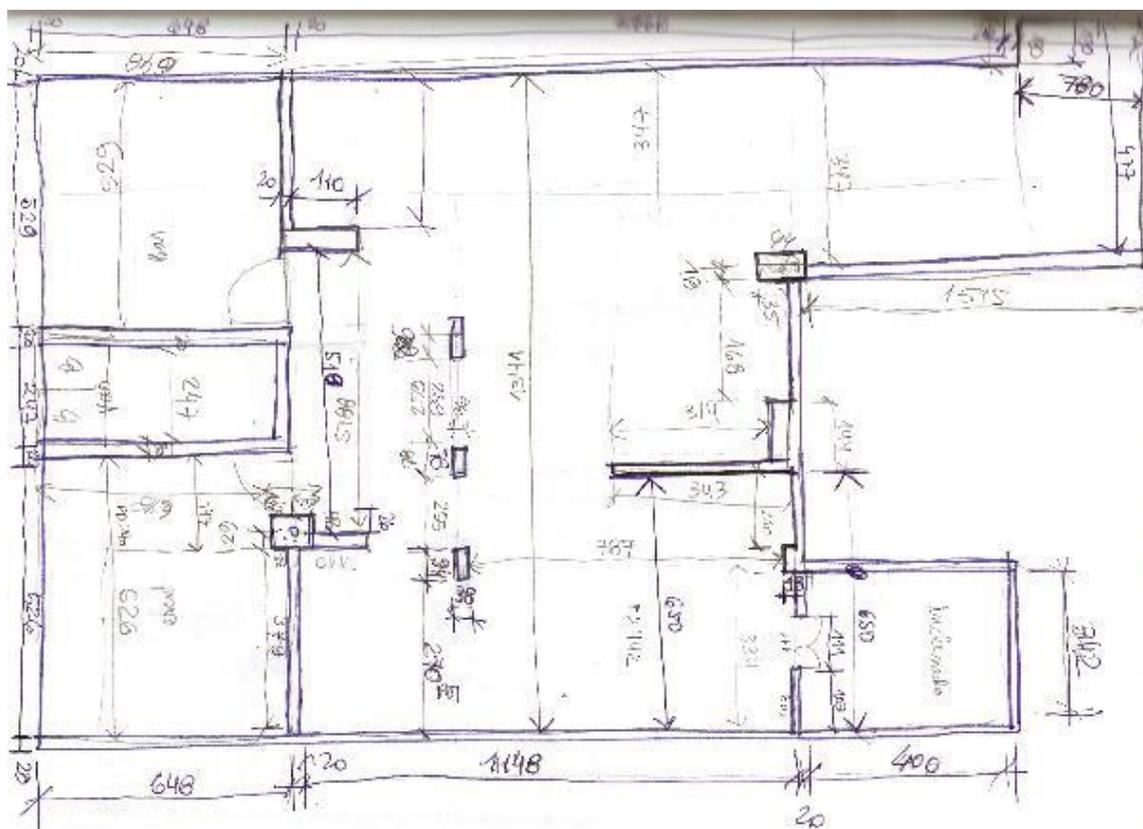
Croqui sem escala representando a planta de levantamento da loja da Rua Bernardo Guimarães. Fonte: Desenho da autora, 2017.
